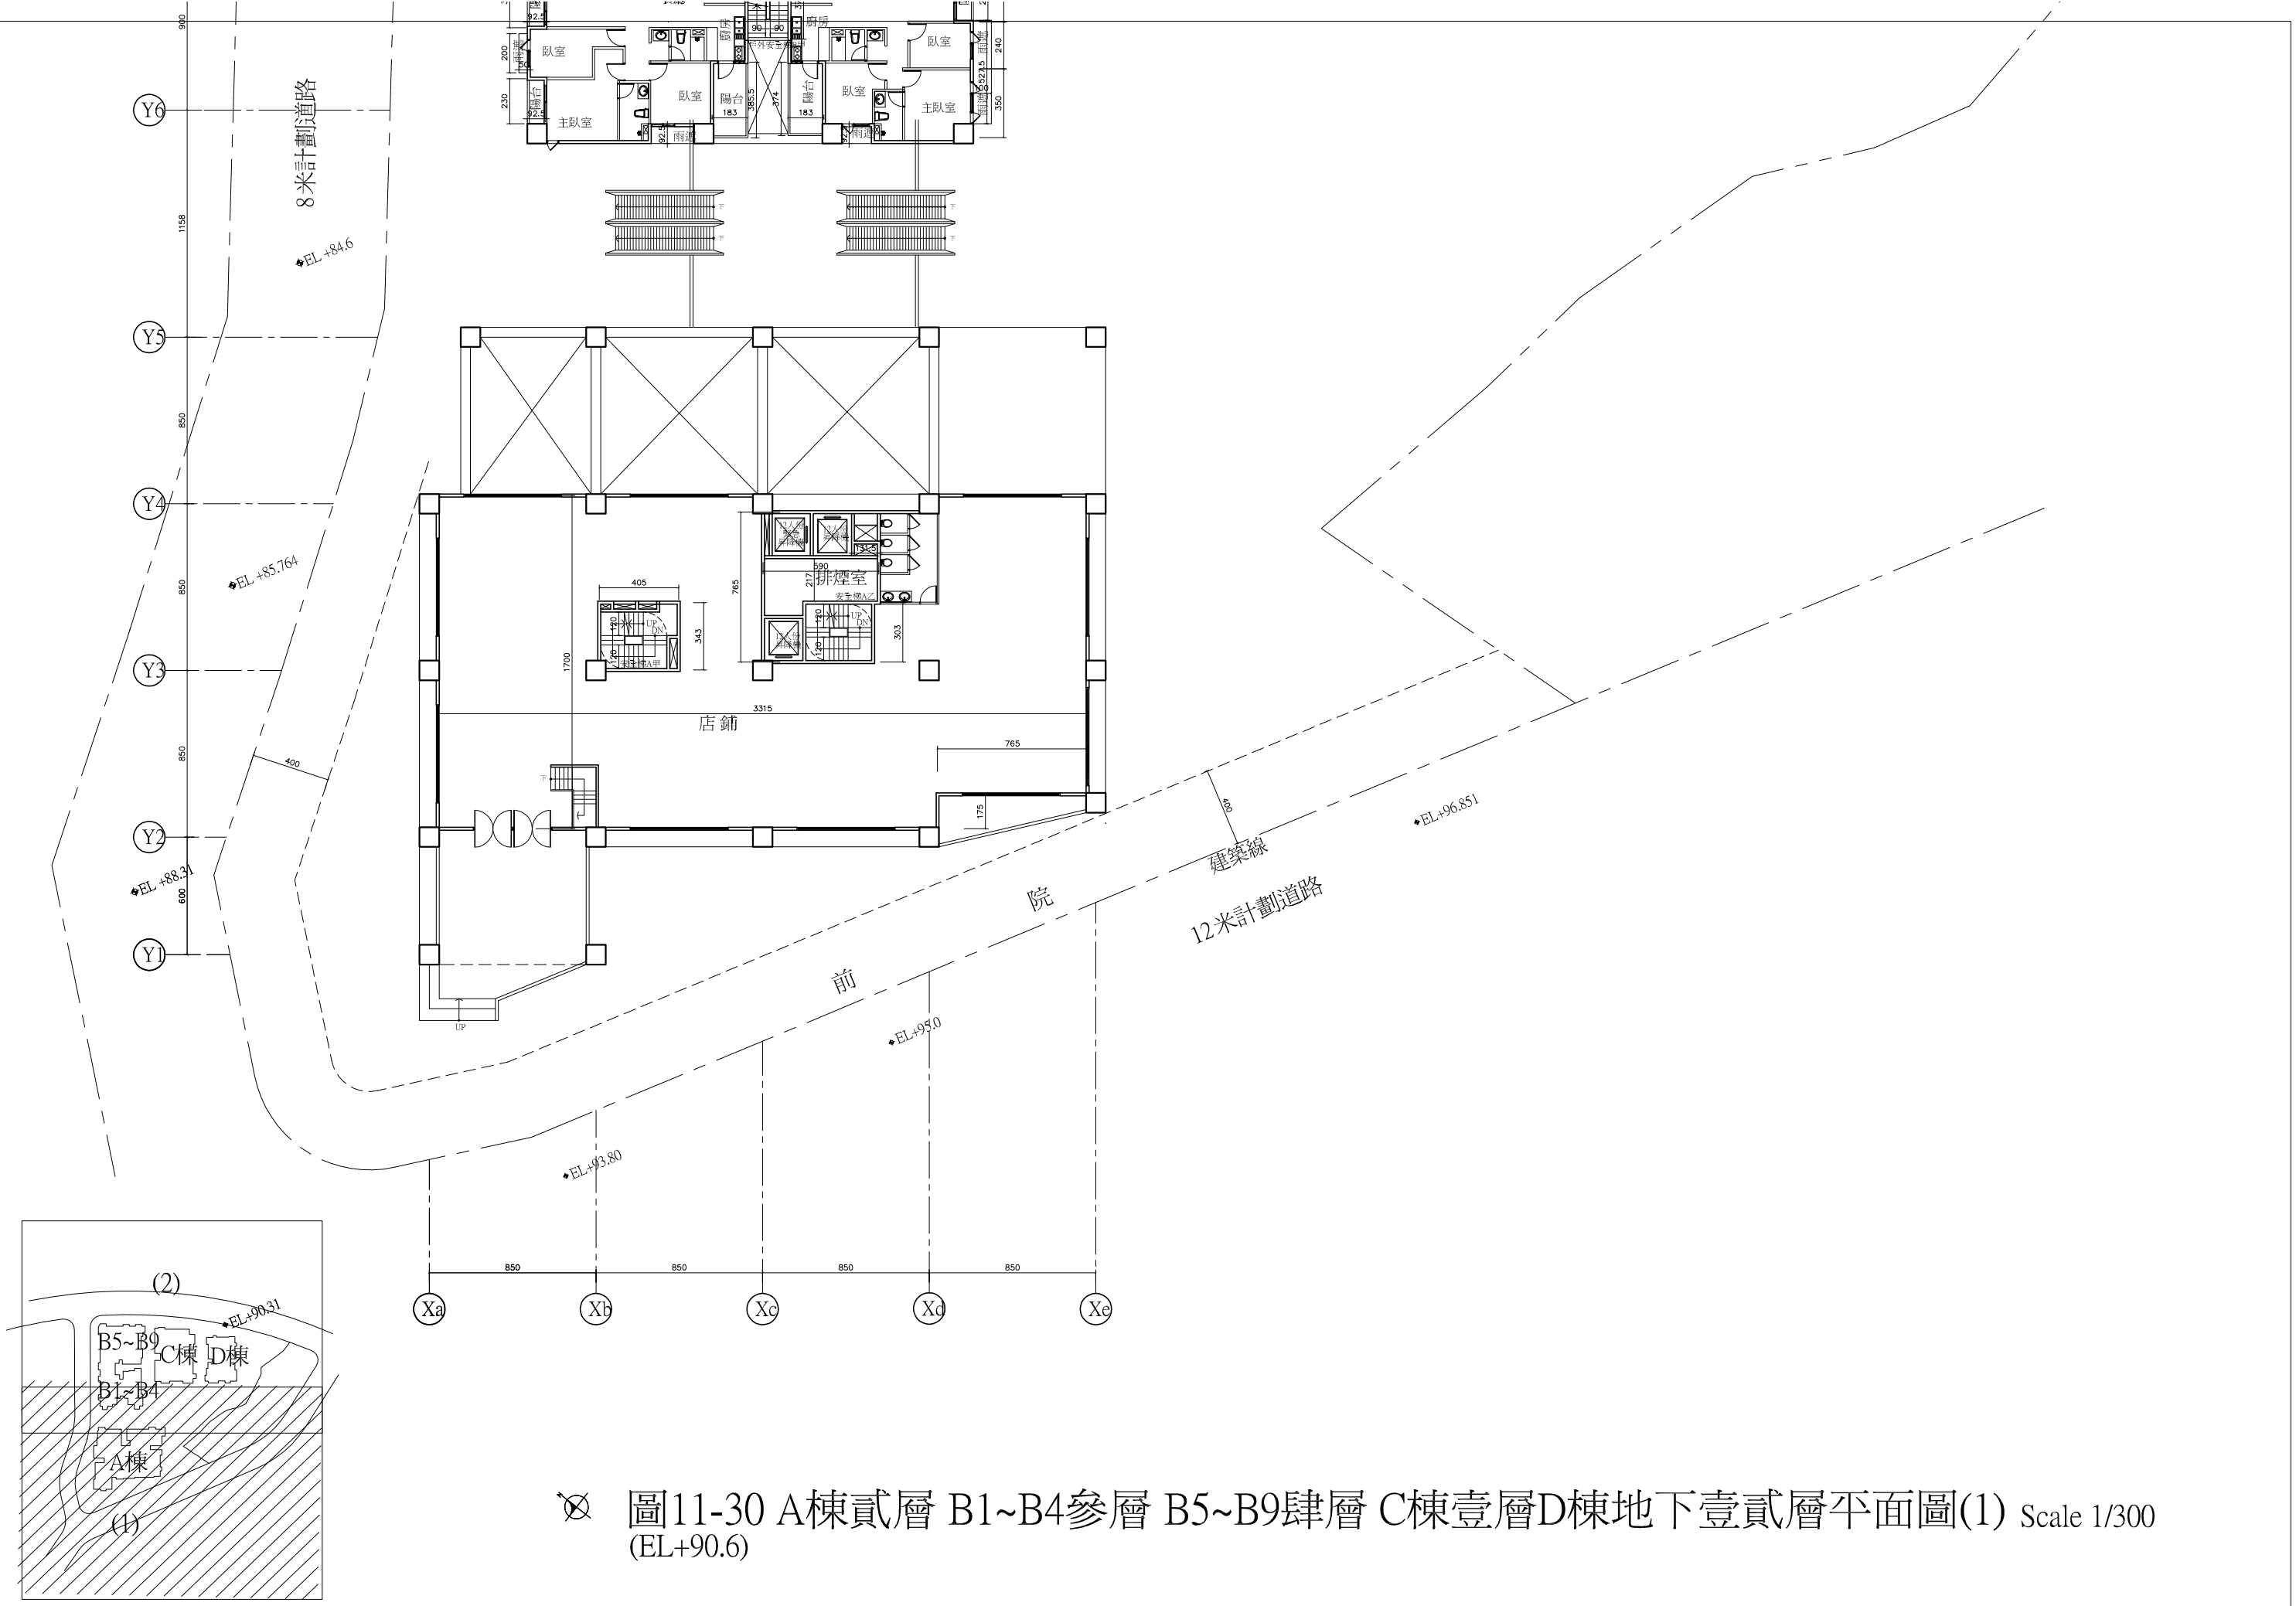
A棟貳層 B1~B4參層 B5~B9肆層 C棟壹層D棟地下壹貳層平面圖(1) Scale 1/300 (EL+90.6)
